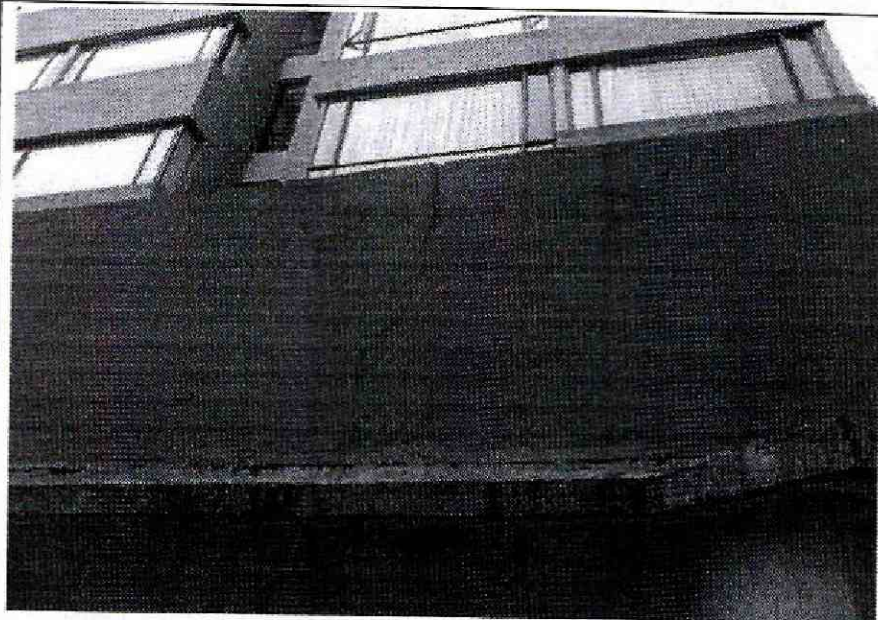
Fisura vertical en la parte superior del muro.
